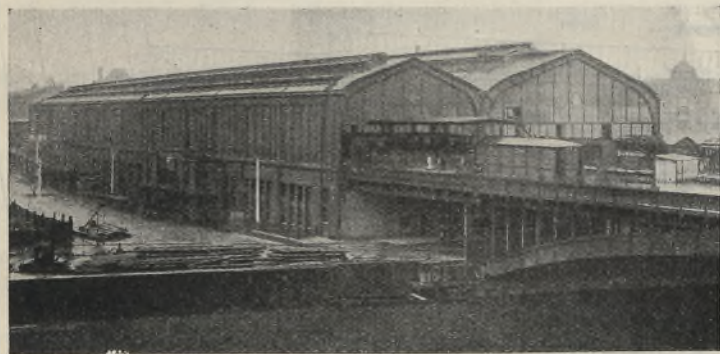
Bahnhof Berlin Friedrichstraße. Gesamtansicht.
